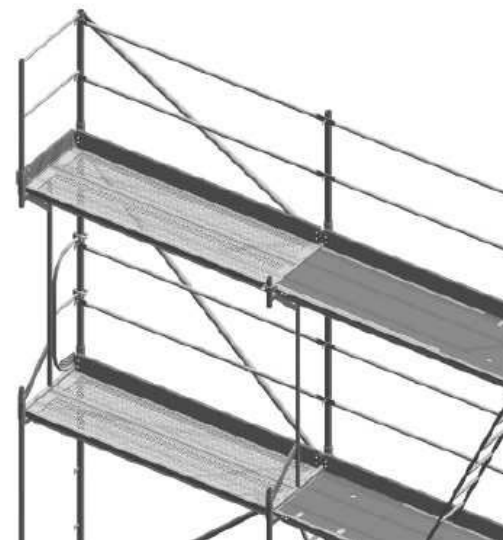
Sposób montażu podestu kąтового i jego zabezpieczeń
